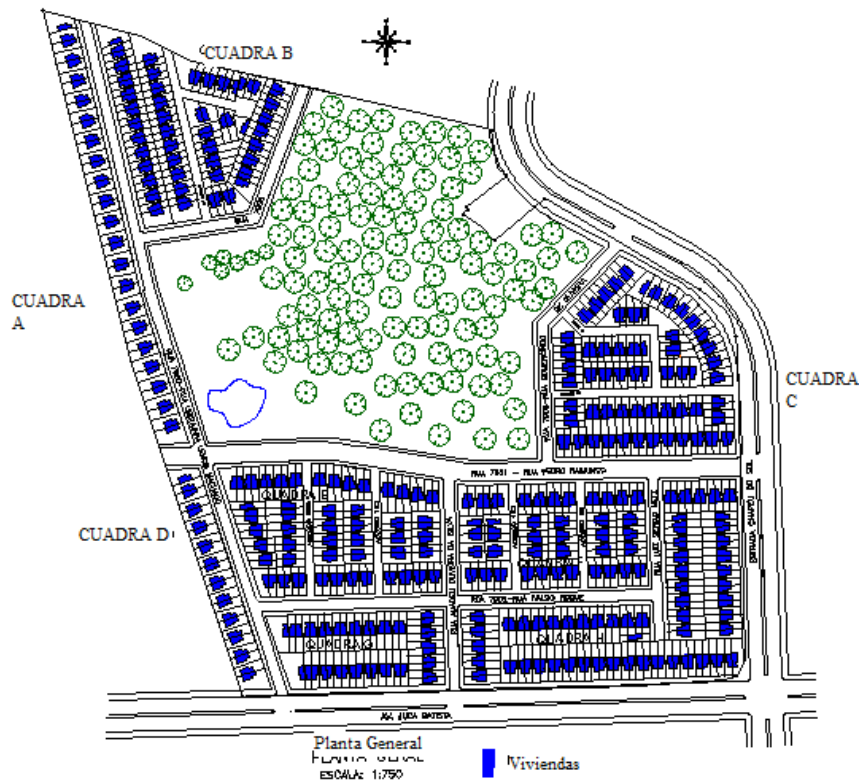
Planta de urbanización propuesta en el proyecto – Archivos Demhab.
